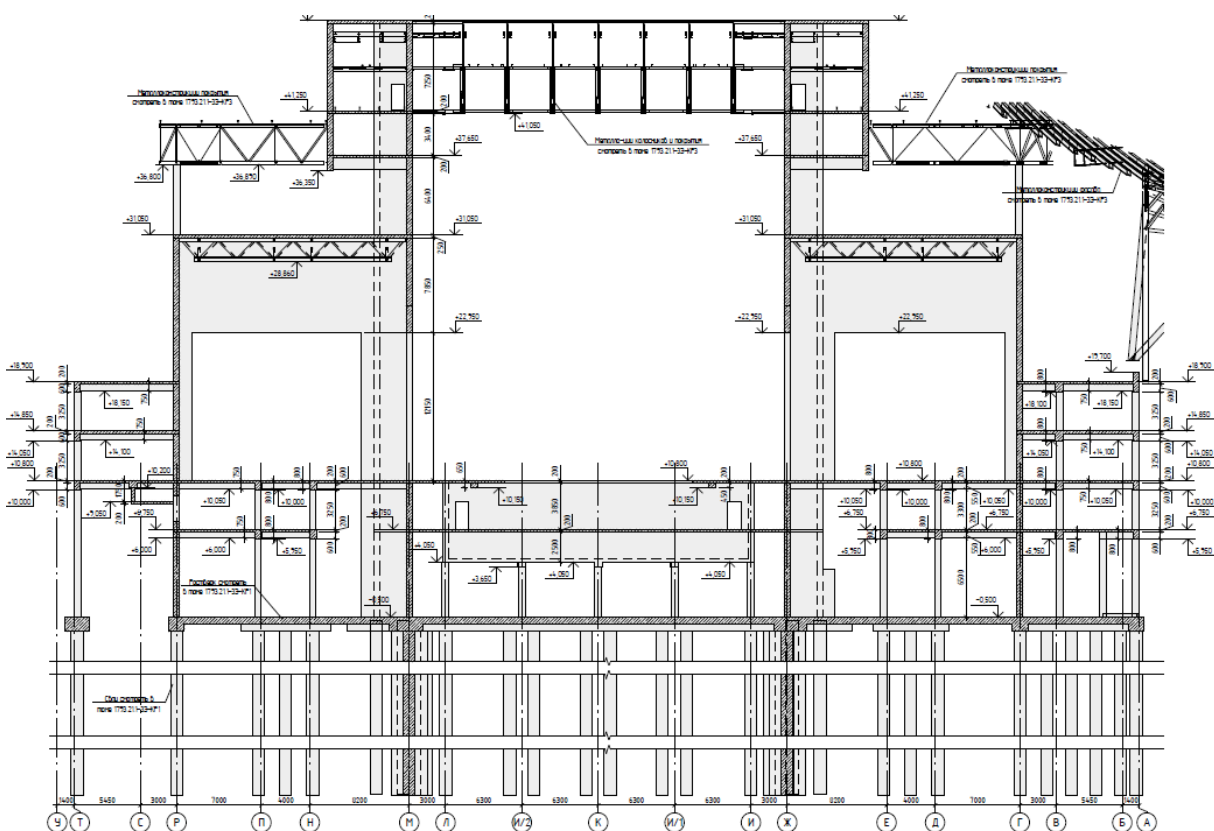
Поперечный разрез по зданию Театра оперы и балета
